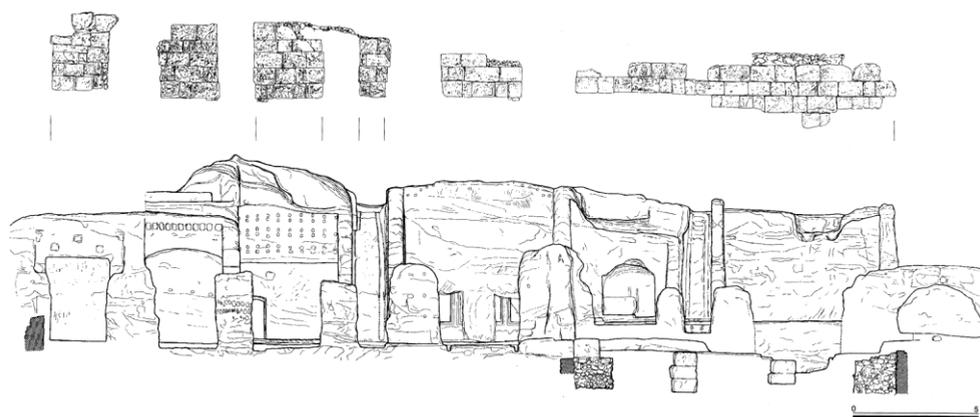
Alzado de la muralla romana sobre el conjunto rupestre del sur (Argente, coord., 1995).
